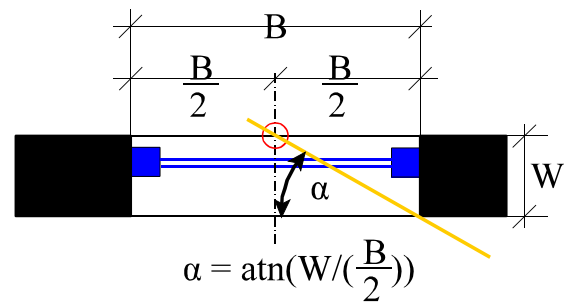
Lage des Nachweisortes (Kreis) für Besonnung nach EN 17037 im Grundriss
